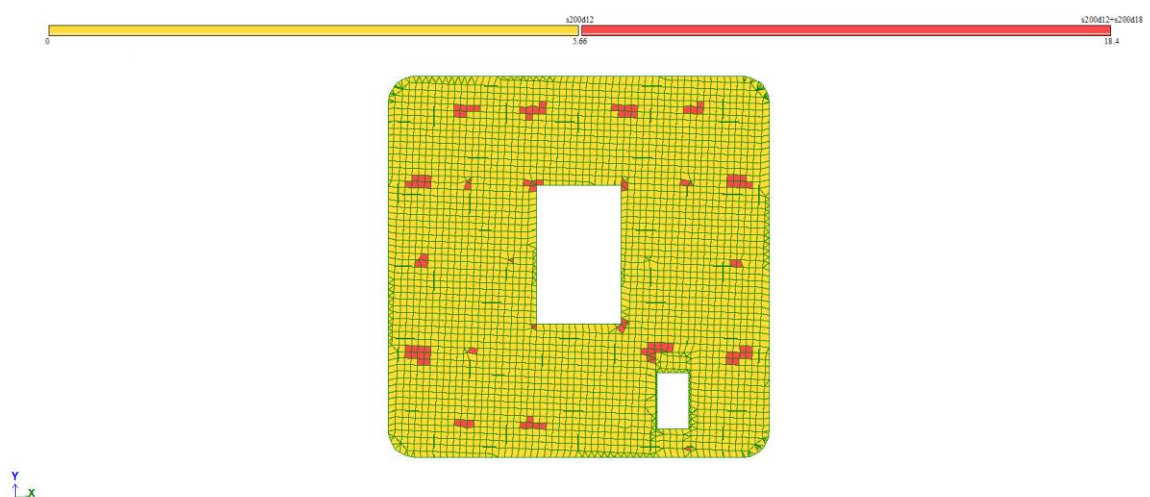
Верхнее армирование плиты перекрытия по оси X
